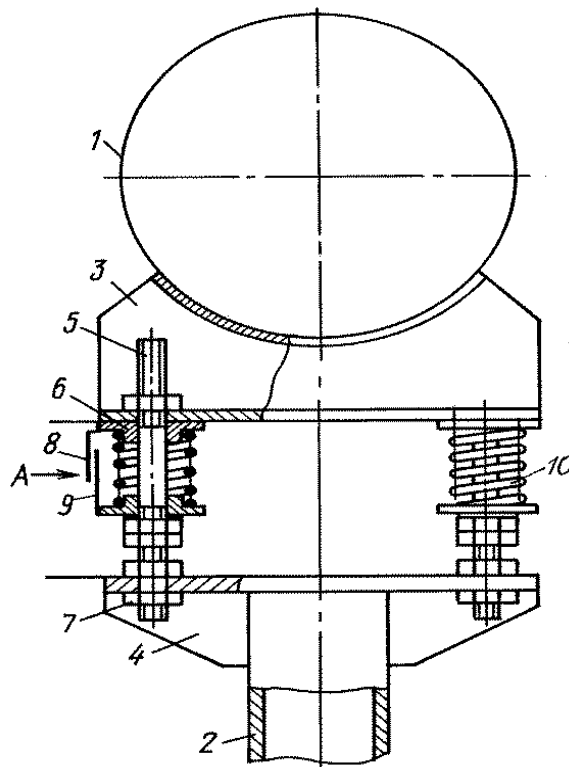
Схема опоры с пружинами: 1 – трубопровод; 2 – свайная опора; 3 – ложемент; 4 – платформа; 5 – шпилька; 6 – втулка; 7 – гайка; 8 – визир; 9 - мерная планка; 10 – пружина [65]
